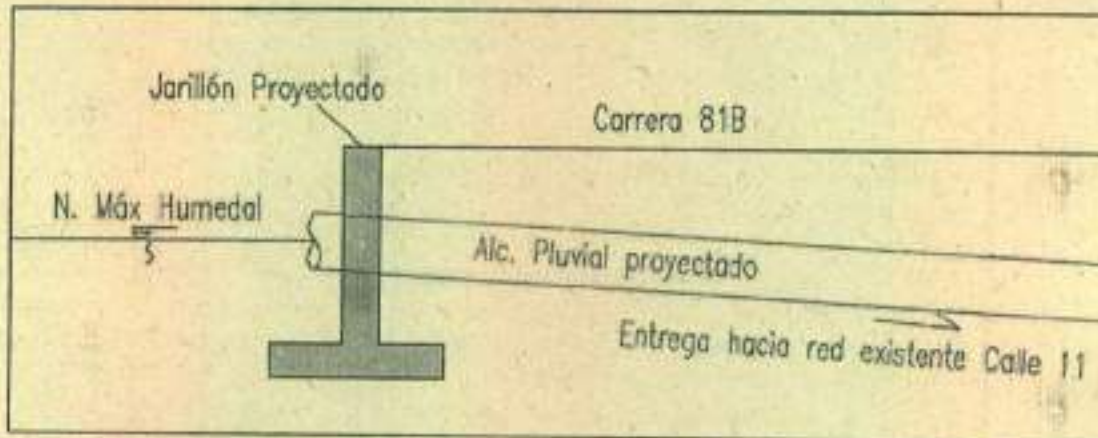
Esquema del jarillón y tubería de rebose que entregaría a las redes proyectadas de Alcantarillado Pluvial que posteriormente entregaría a redes existentes a la altura de la calle 11 con Cra. 81B.
